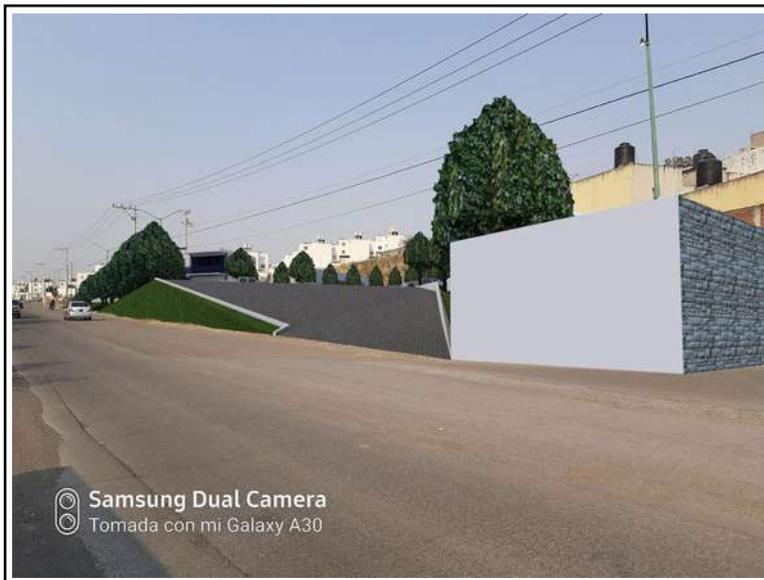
Fotografía de terreno con montaje de render. Vista desde Avenida Las Palmas, esquina con calle sin asignación de nombre. Autor: D.A.M.
